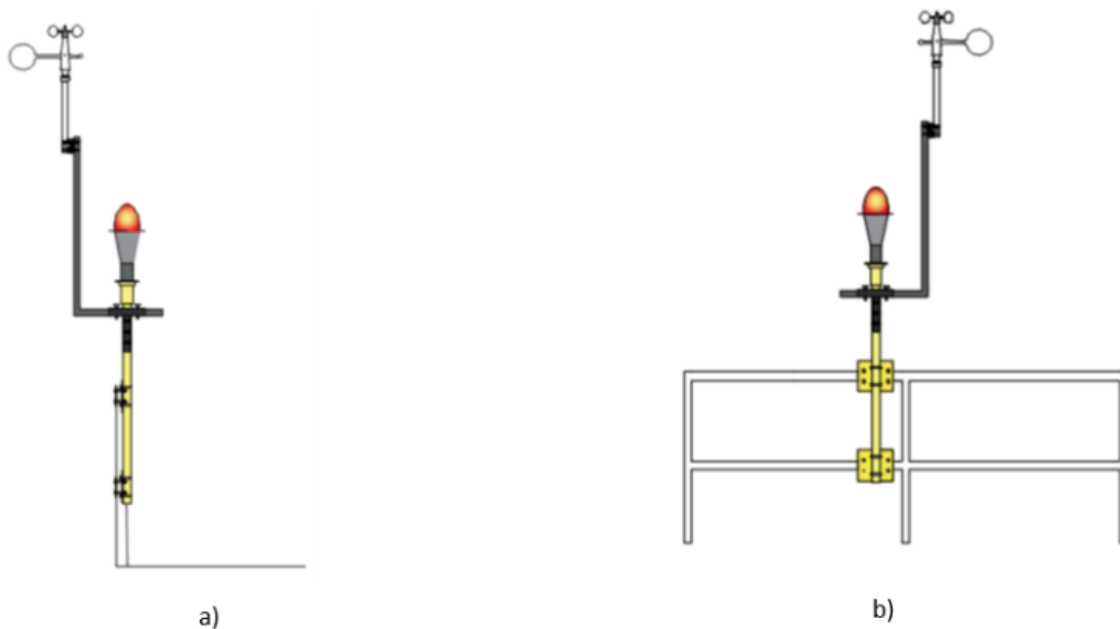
Pormenor de instalação dos anemómetros: a) vista lateral; b) vista frontal
